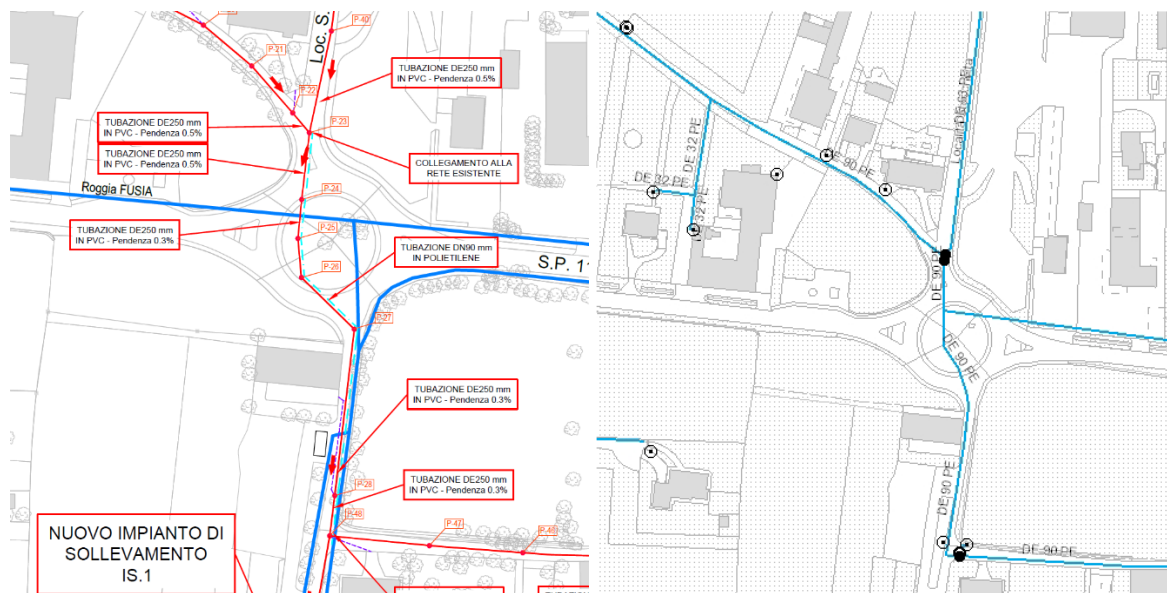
tratto di rifacimento rete acquedotto (a sx) e configurazione di stato di fatto (a dx)
